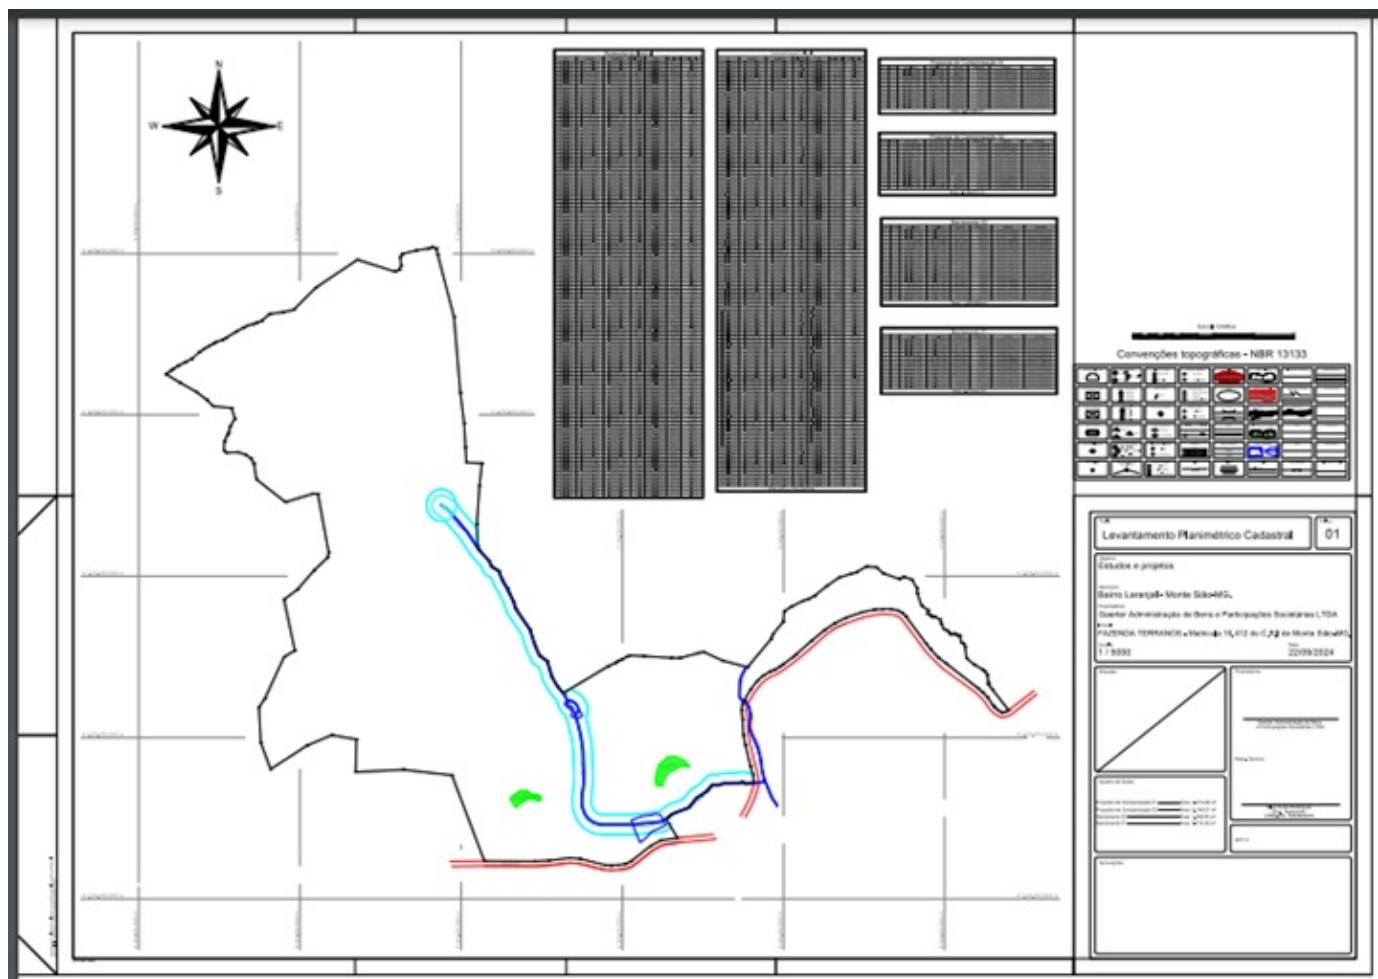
Planta topográfica informando as intervenções solicitadas em app.
